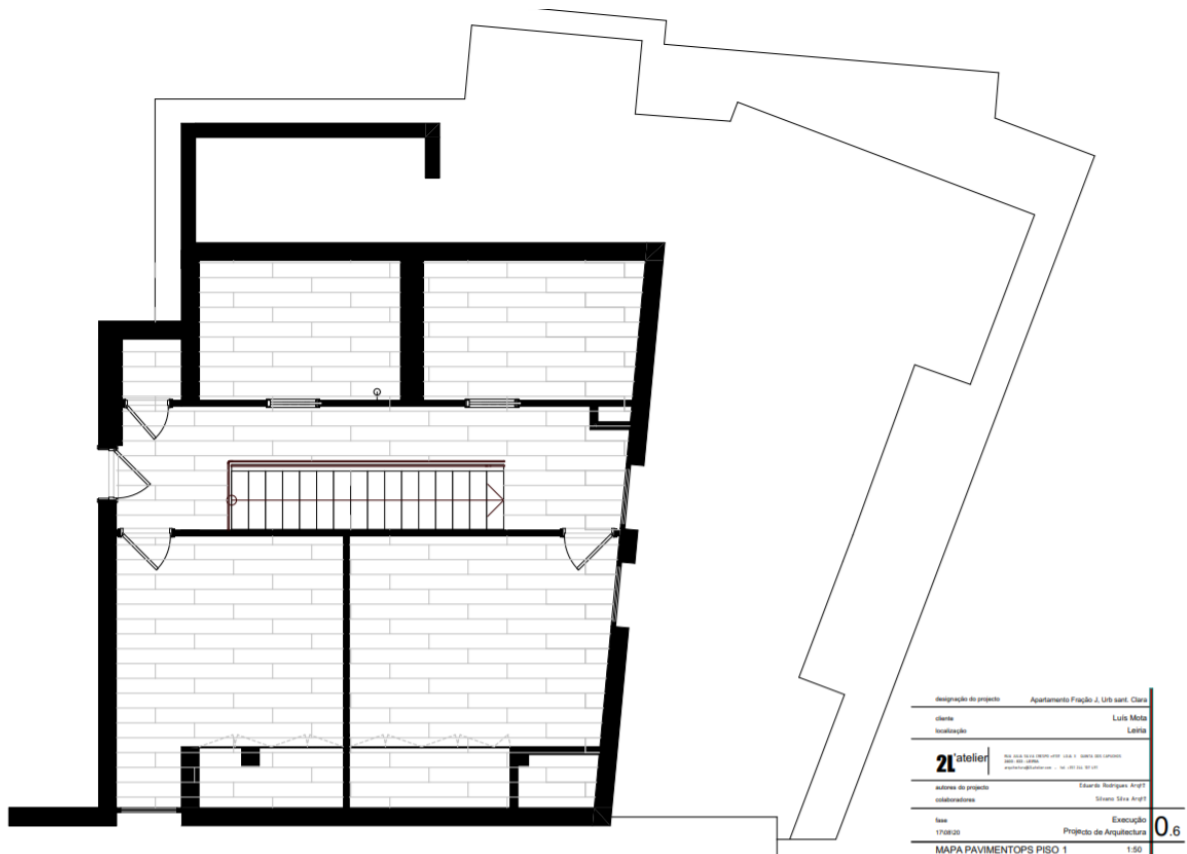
Mapa de pavimento | Piso 1. Fonte: 2L'atelier
